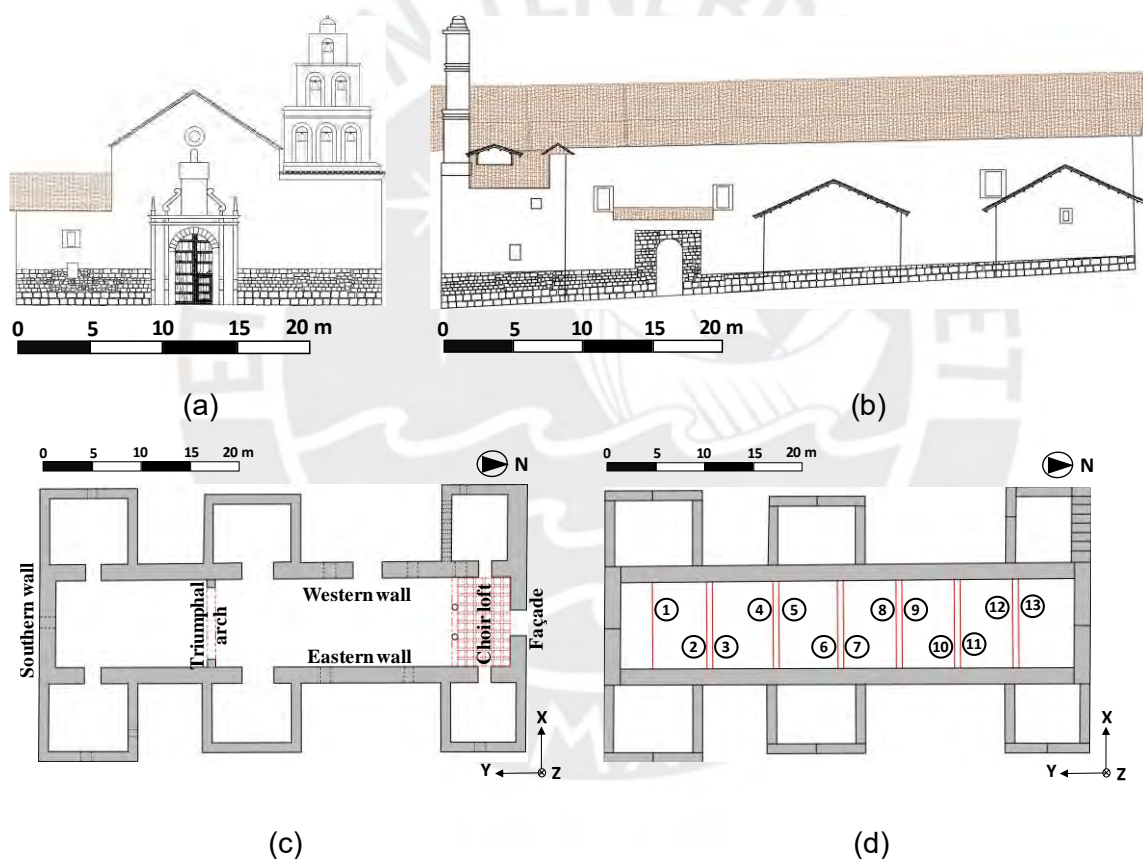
3. Planos de la iglesia: (a) fachada, (b) vista en elevación del muro oeste, (c) vista en planta del templo, (d) vista esquemática en planta de las vigas de madera de techo. Adaptado de Noel (2017).
